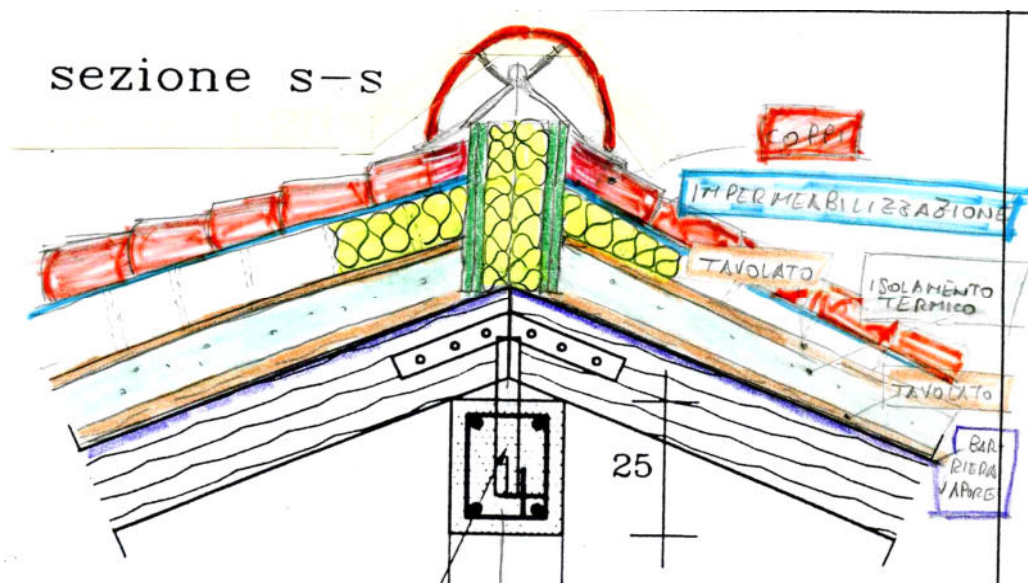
Schema del tetto ventilato, modificato (soluzione 1)
